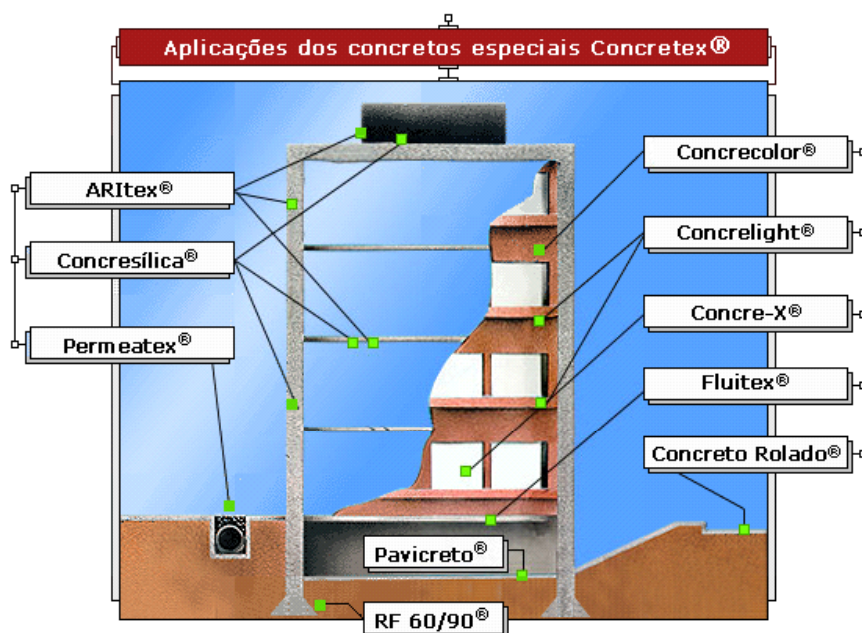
Aplicação dos concretos especiais (Fonte: www.concretex.com.br)
